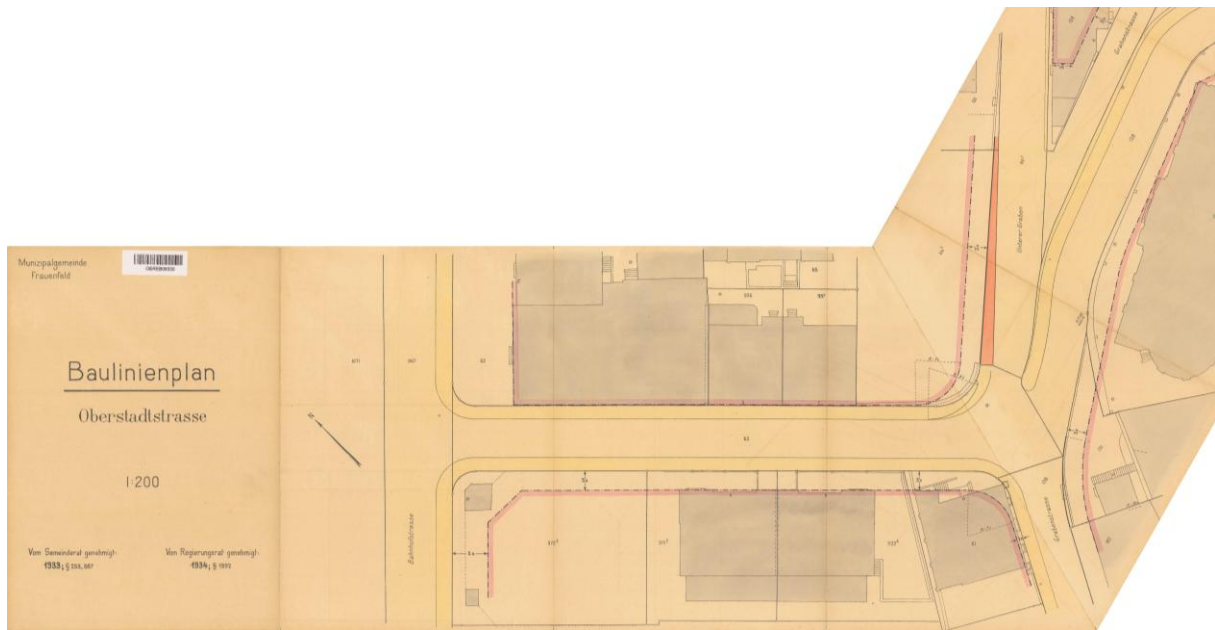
Ausschnitt Baulinienplan Oberstadtstrasse (RRB Nr. 1392 vom 25.06.1934)
